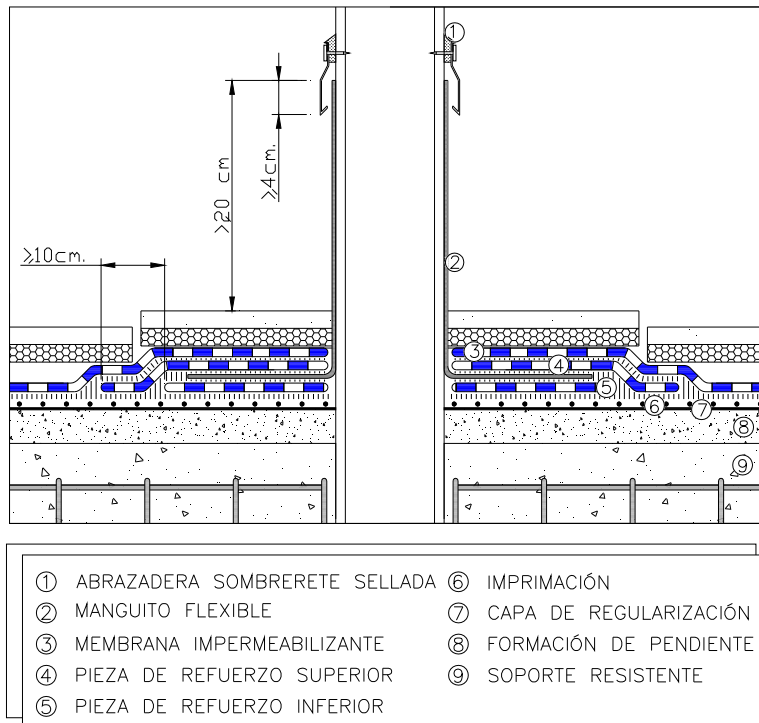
ejemplo de encuentro de un faldón con un elemento pasante solucionado con manguito flexible
